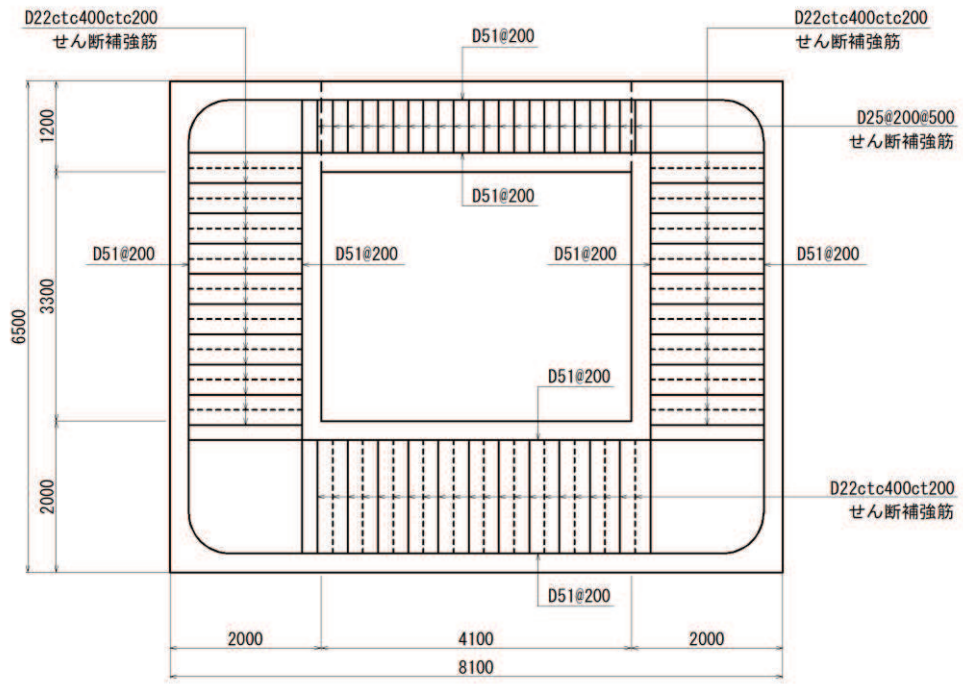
集水ピットの概略配筋図 (単位 : mm)
